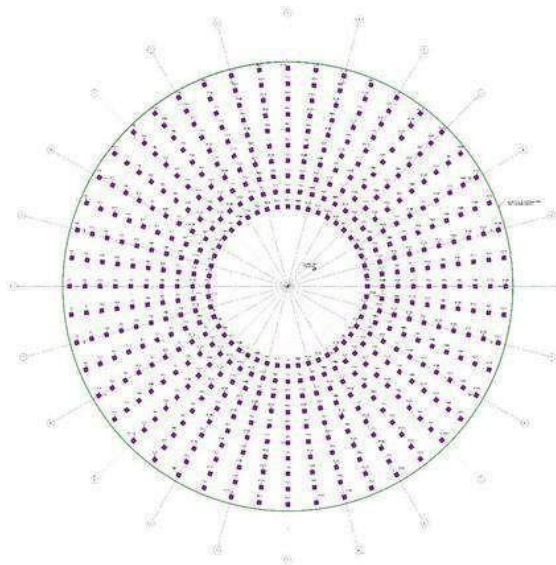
Sistema de distribución de pilotes de la TCTA,
